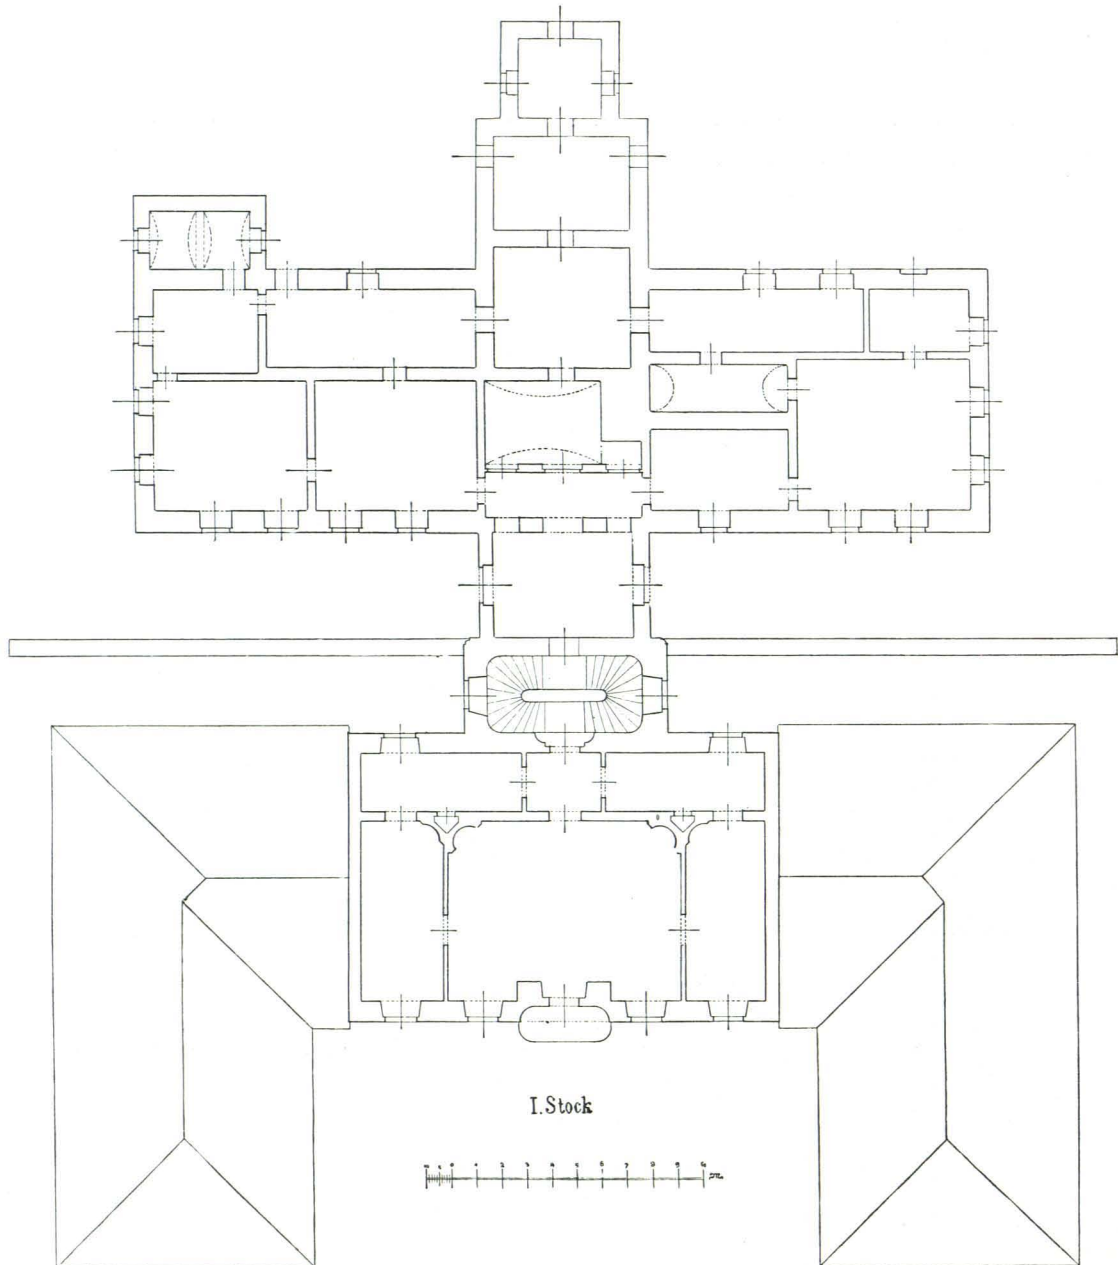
Schloß Gutenbrunn, Grundriß des I. Stockes, 1:300 (S. 43)
